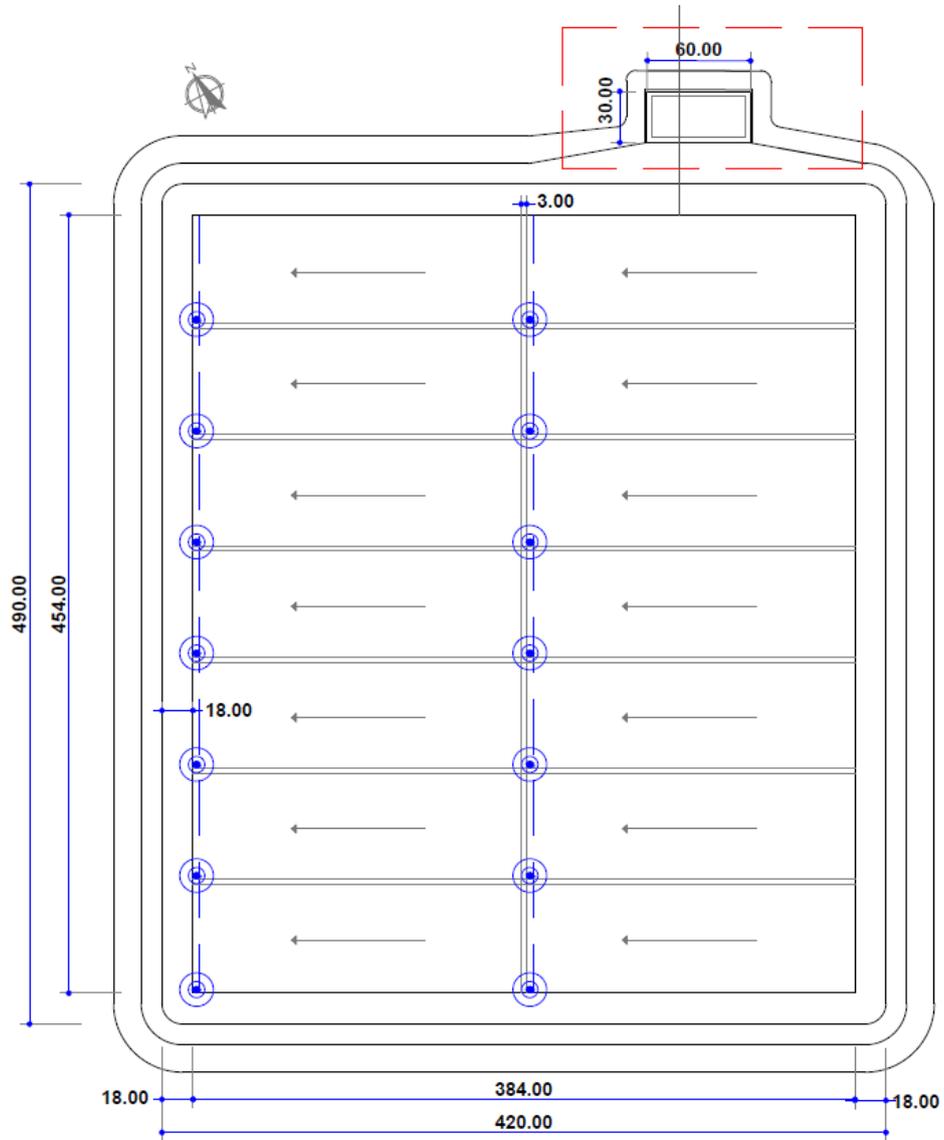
Planta Módulo 1 – Ubicación laguna lixiviados
